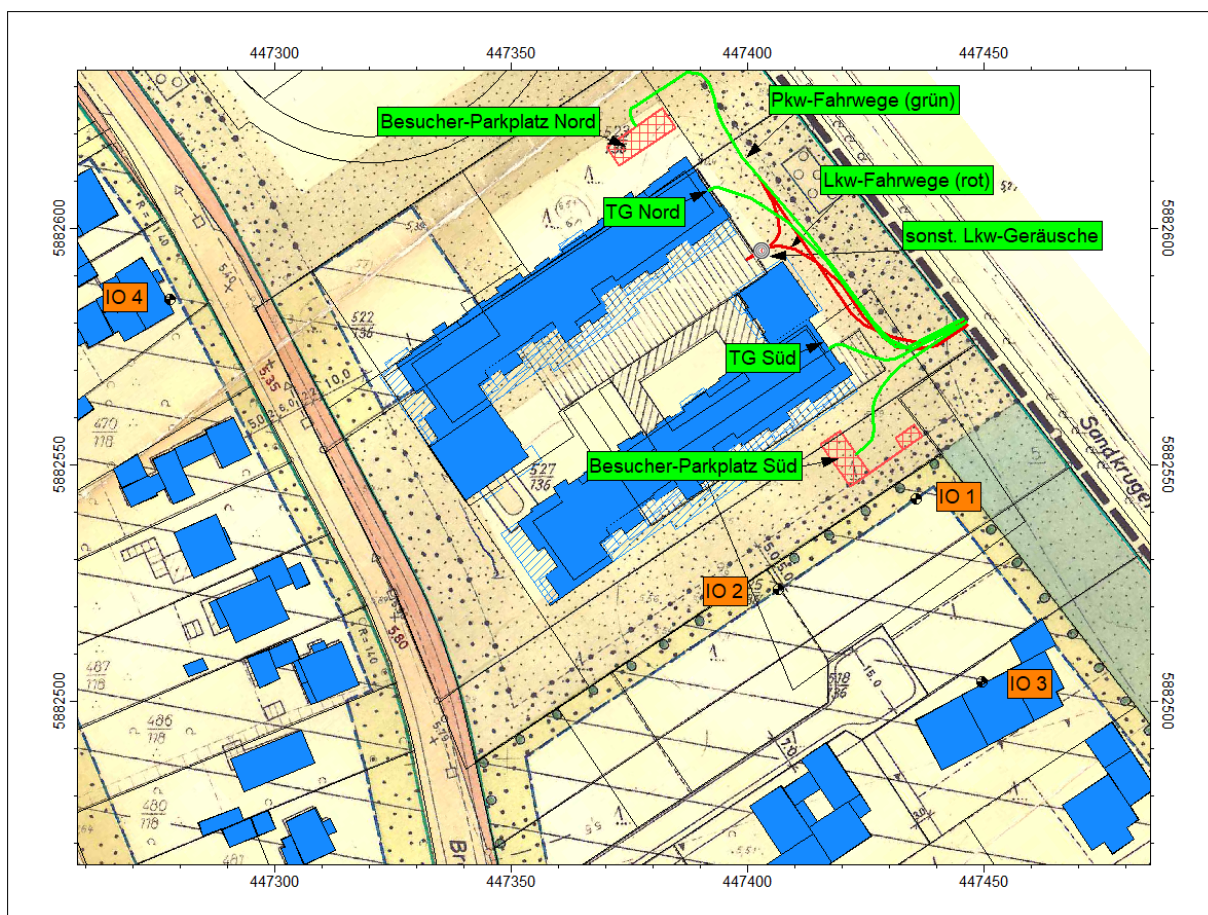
Lage der Schallquellen und Immissionsorte, hinterlegter Plan: Quelle: /22/.
